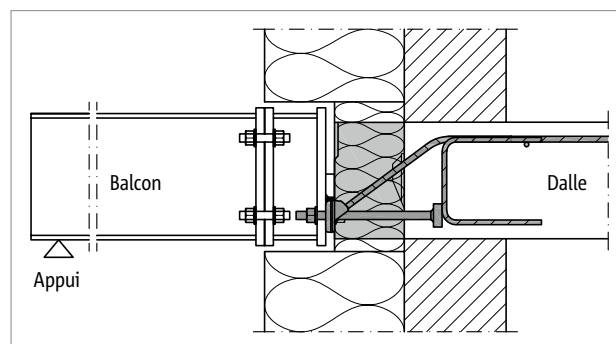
Schöck Isokorb® XT type SQ : raccordement de la poutre en acier à un adaptateur permettant de compenser l'épaisseur de l'isolation thermique extérieure
